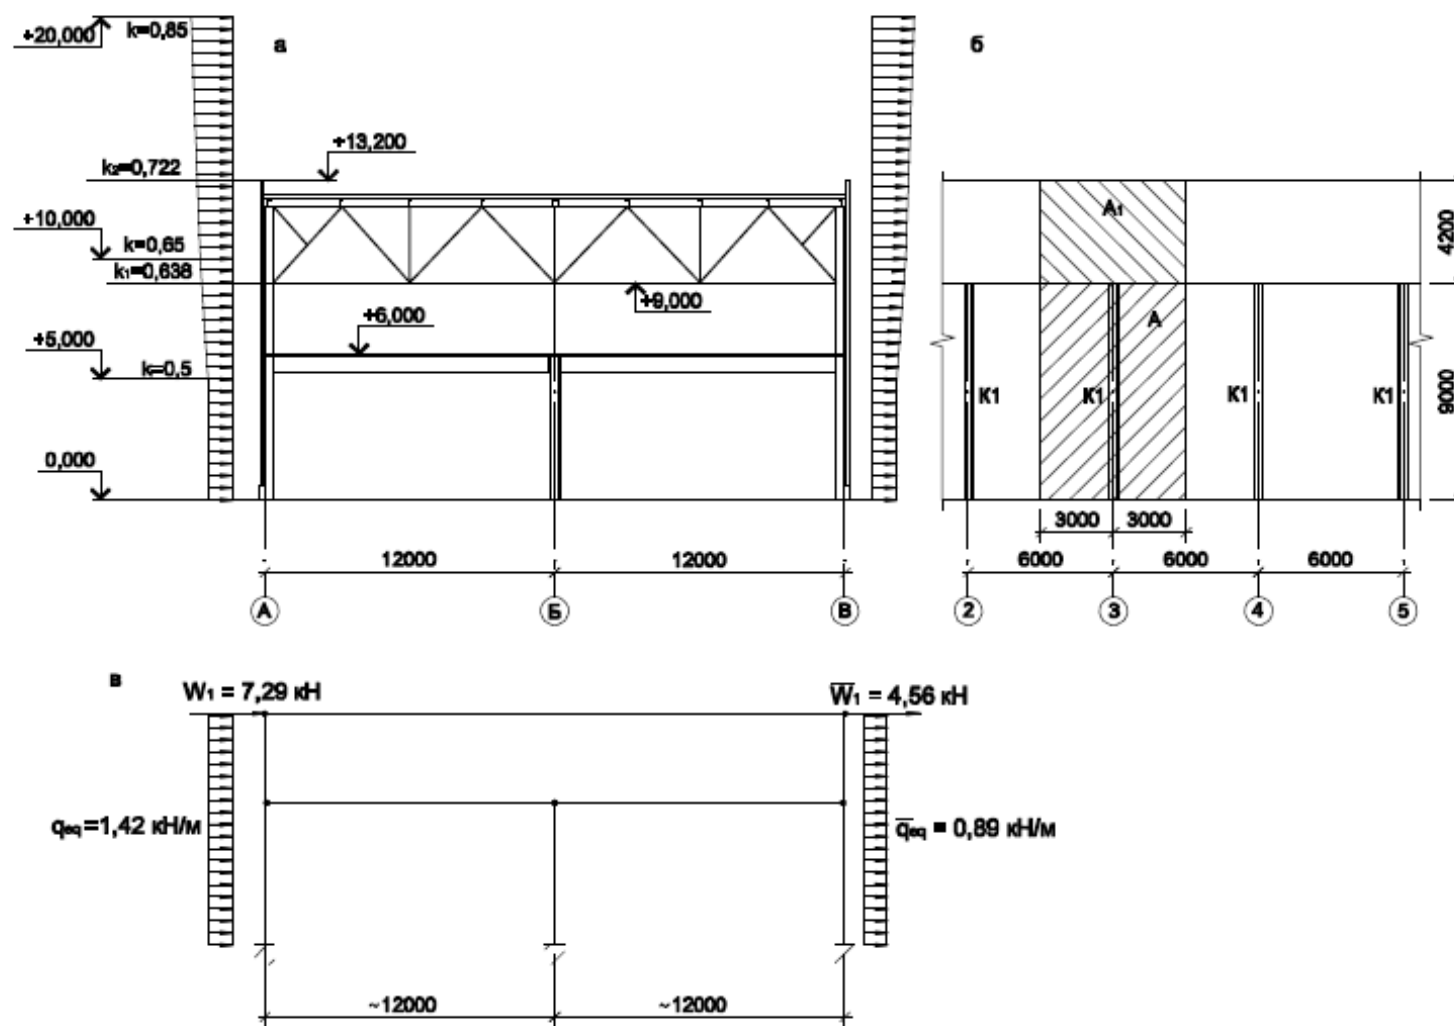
Схема загрузки рамы ветровой нагрузкой
